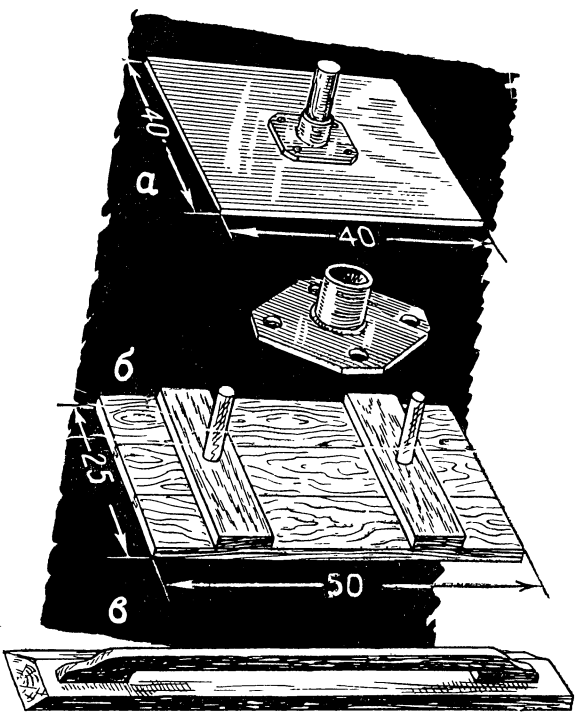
Штукатурный инструмент: а — деревянный сокол; б — полутёрка для потолка; в — полутёрка
